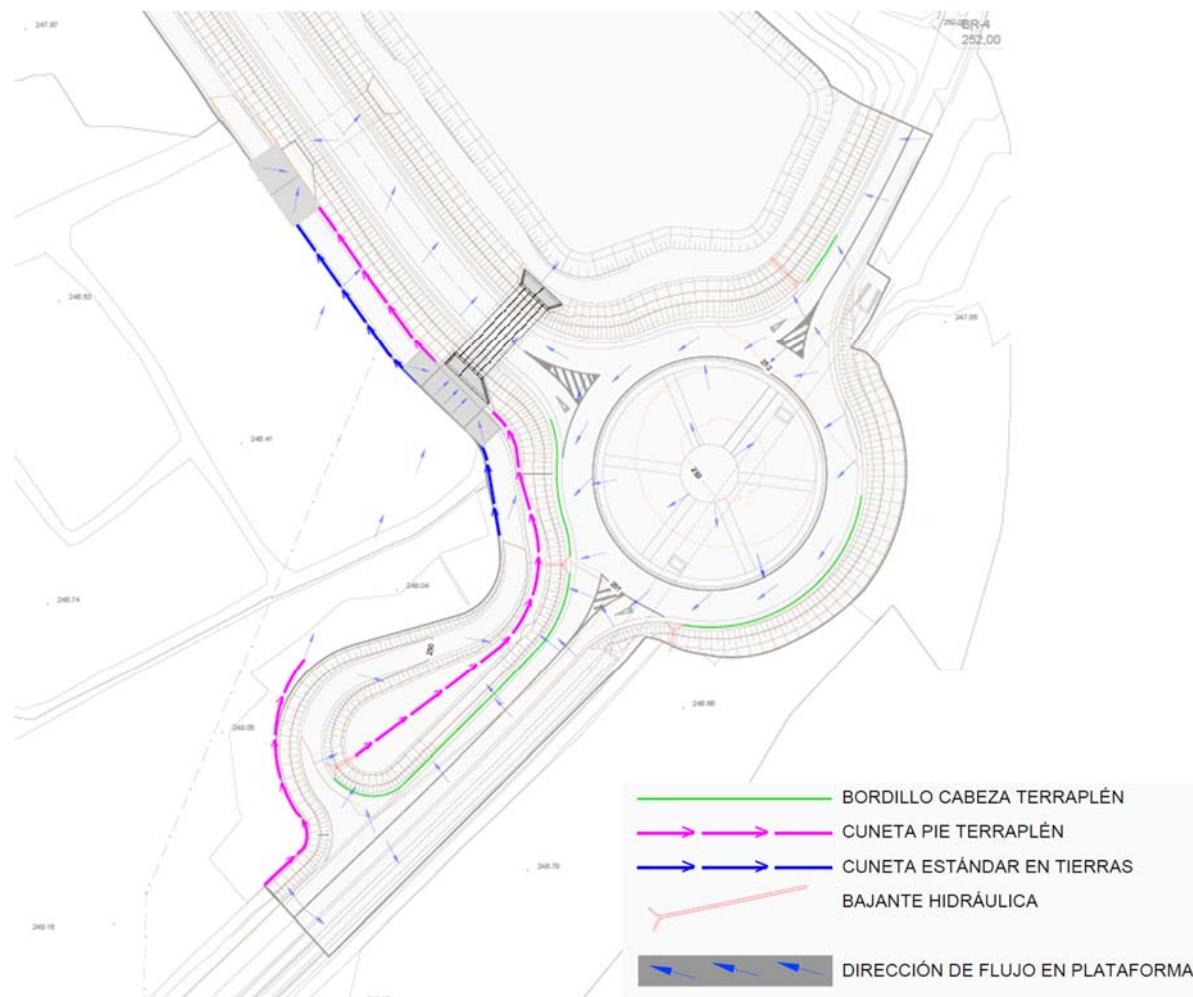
Drenaje (Plano 8.5.1. del Proyecto)
